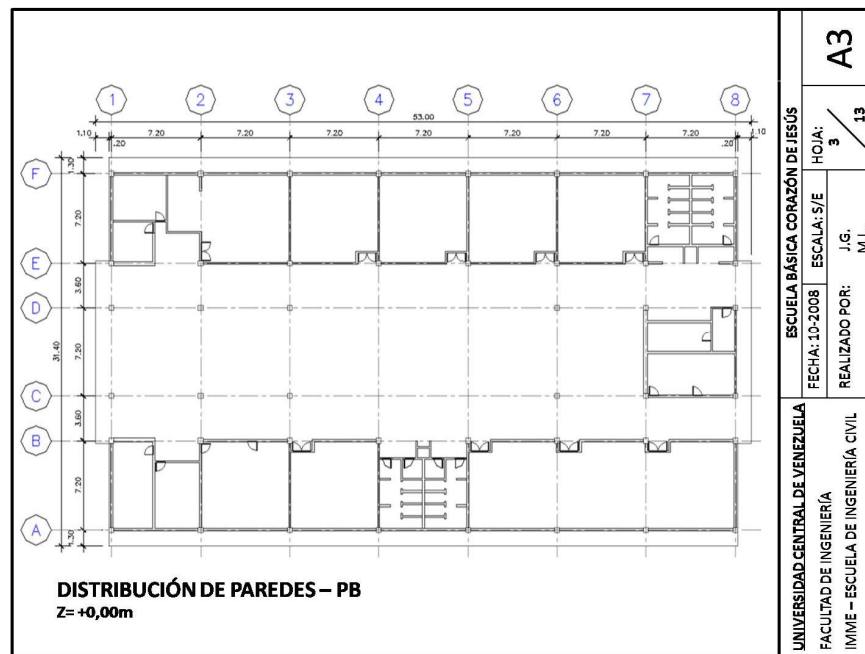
Distribución de paredes de mampostería en la planta baja.
